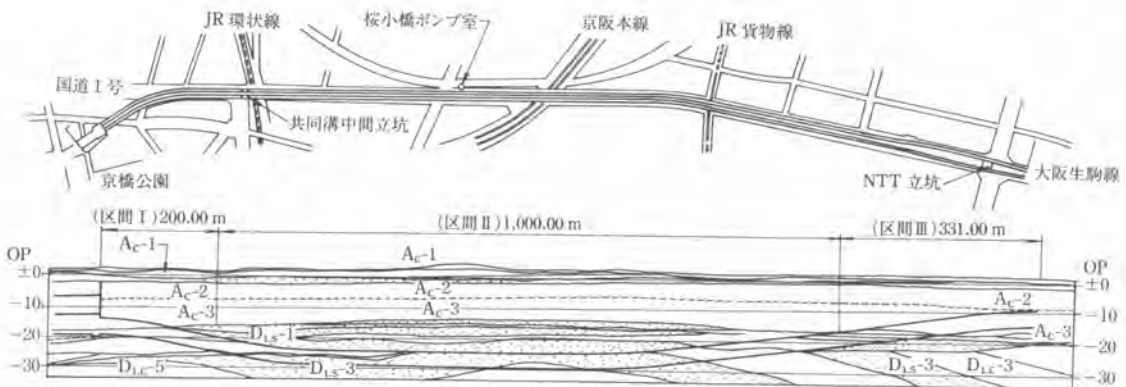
京橋~蒲生四丁目間平面図および土質縦断図
